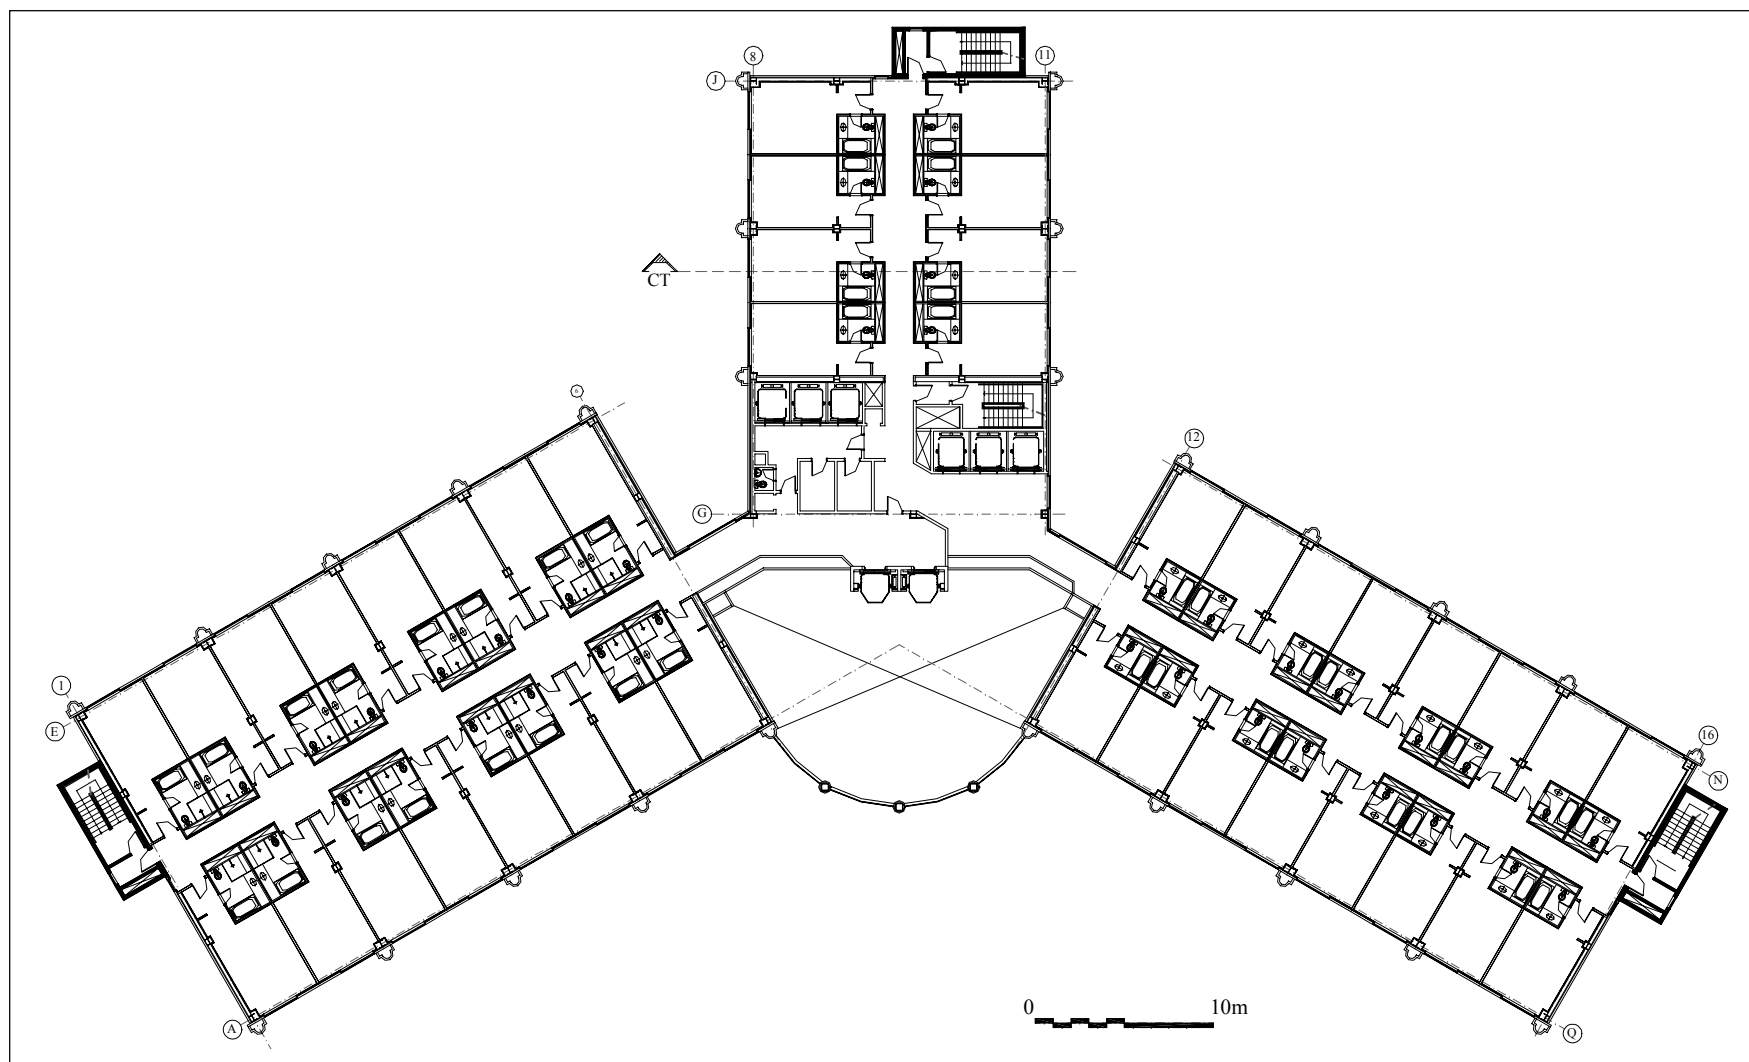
Solução arquitetônica do edifício E-1: esboço da planta do segundo ao nono pavimento.
